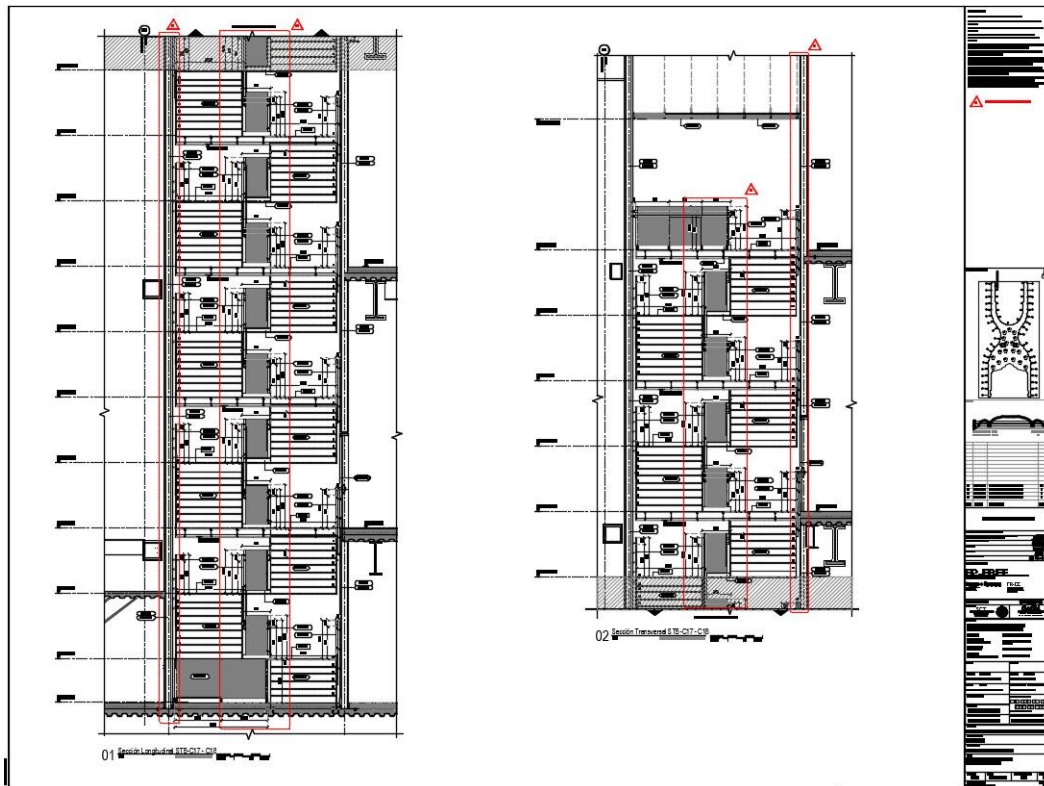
Secciones Arquitectónicas a Detalle 2
